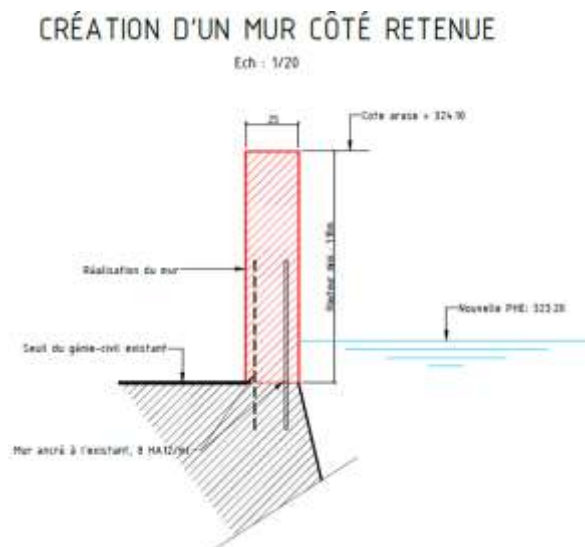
Coupe – schéma de principe d'une structure pare-crue (exemple d'une structure béton armée ancrée)
